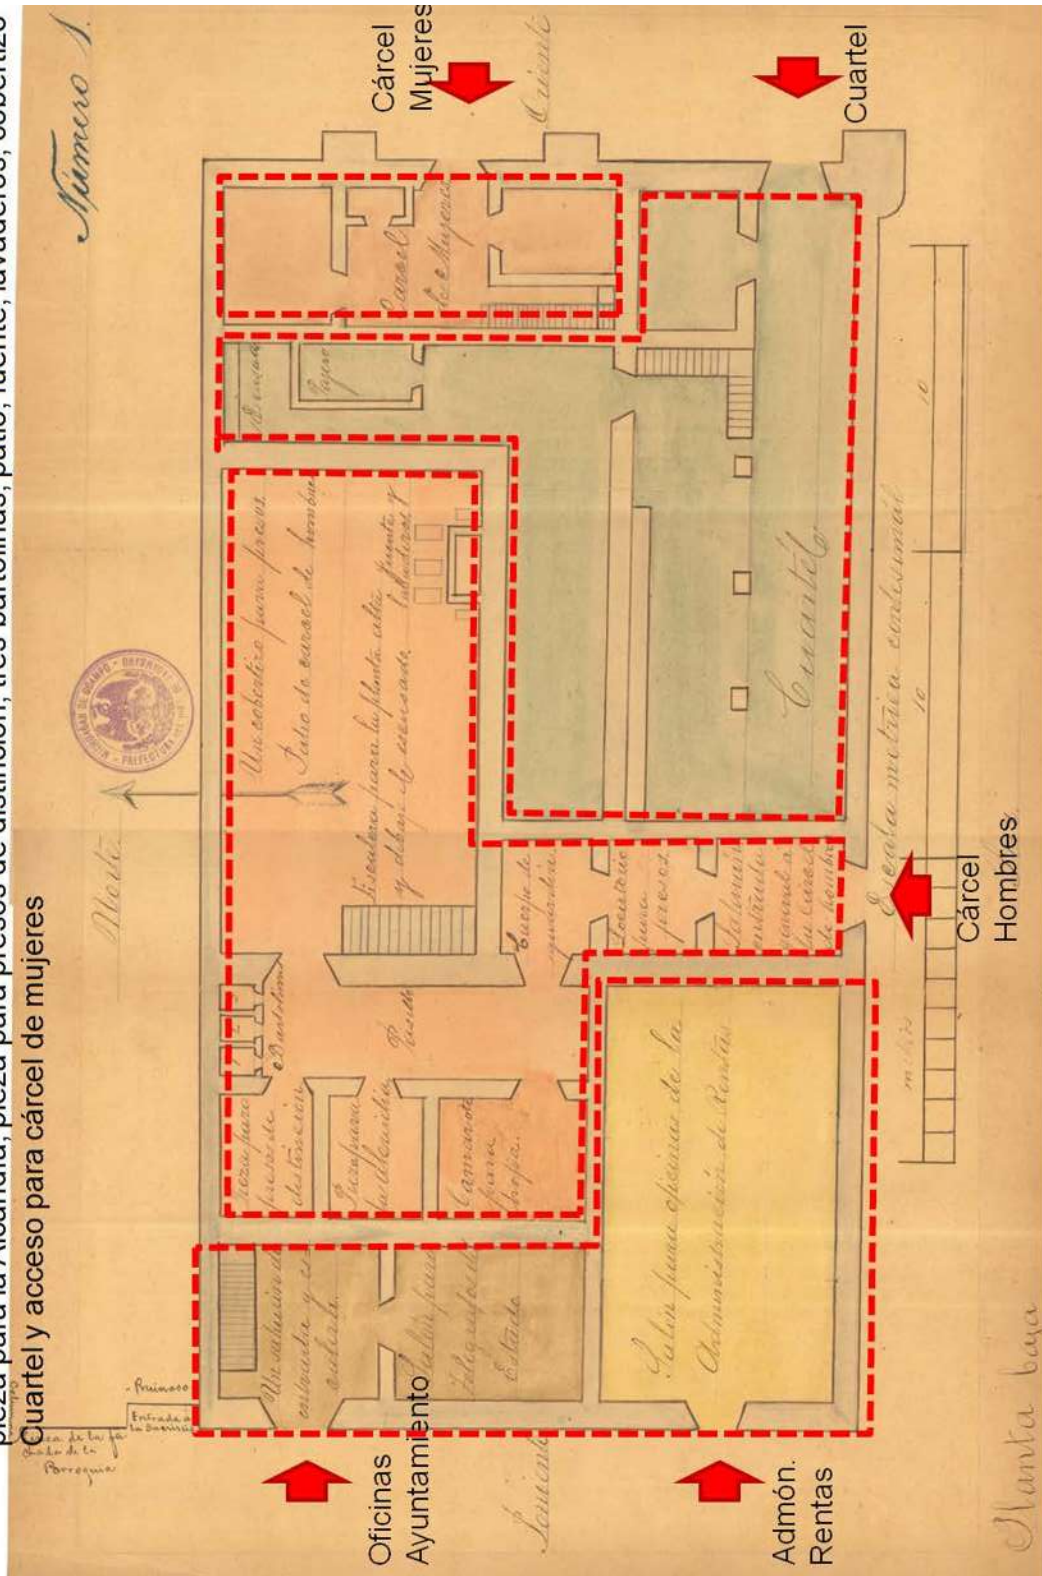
Plano de planta baja de la Casa Municipal de Tacámbaro de Codallos de 1909.
